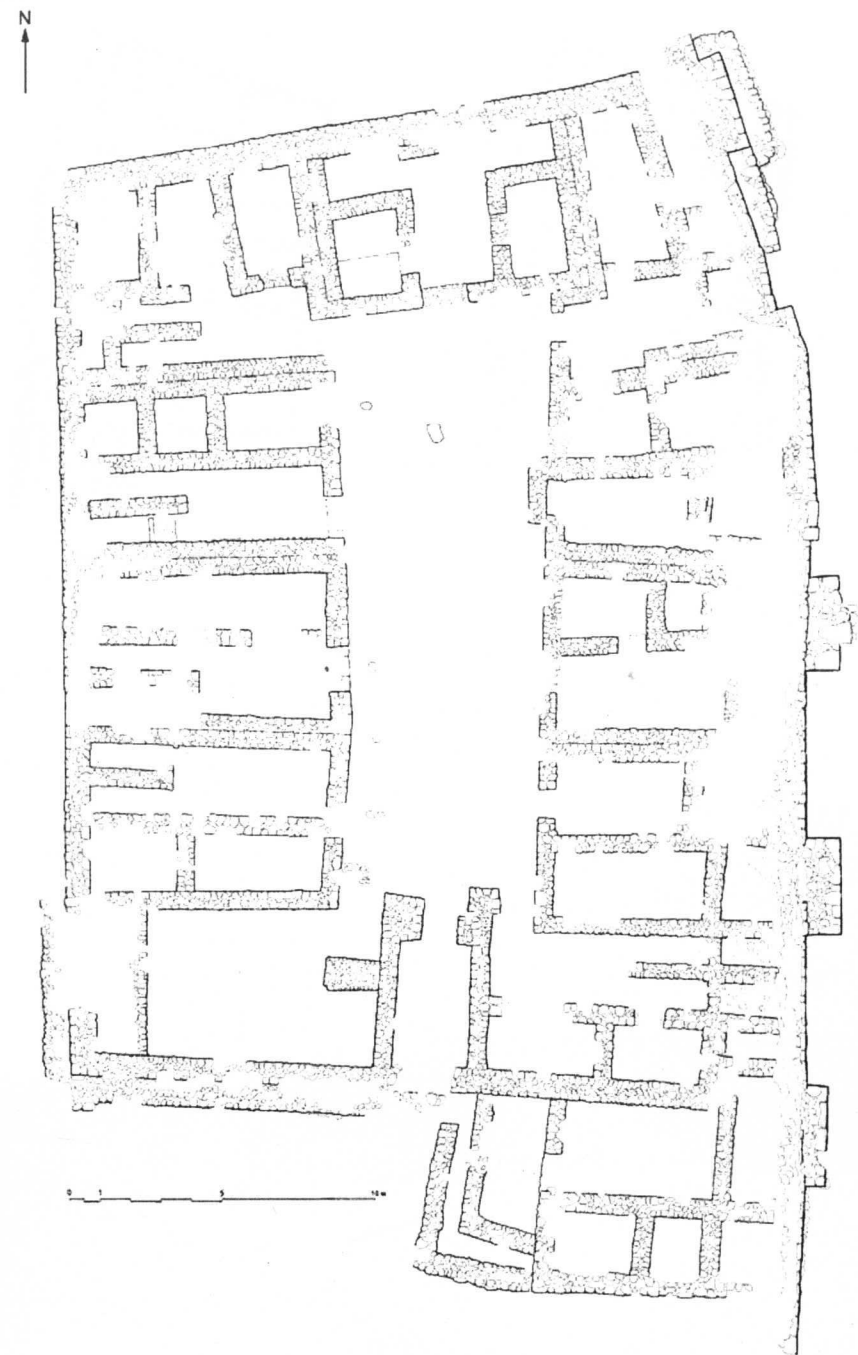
Plan du bâtiment A et du rempart adjacent.
